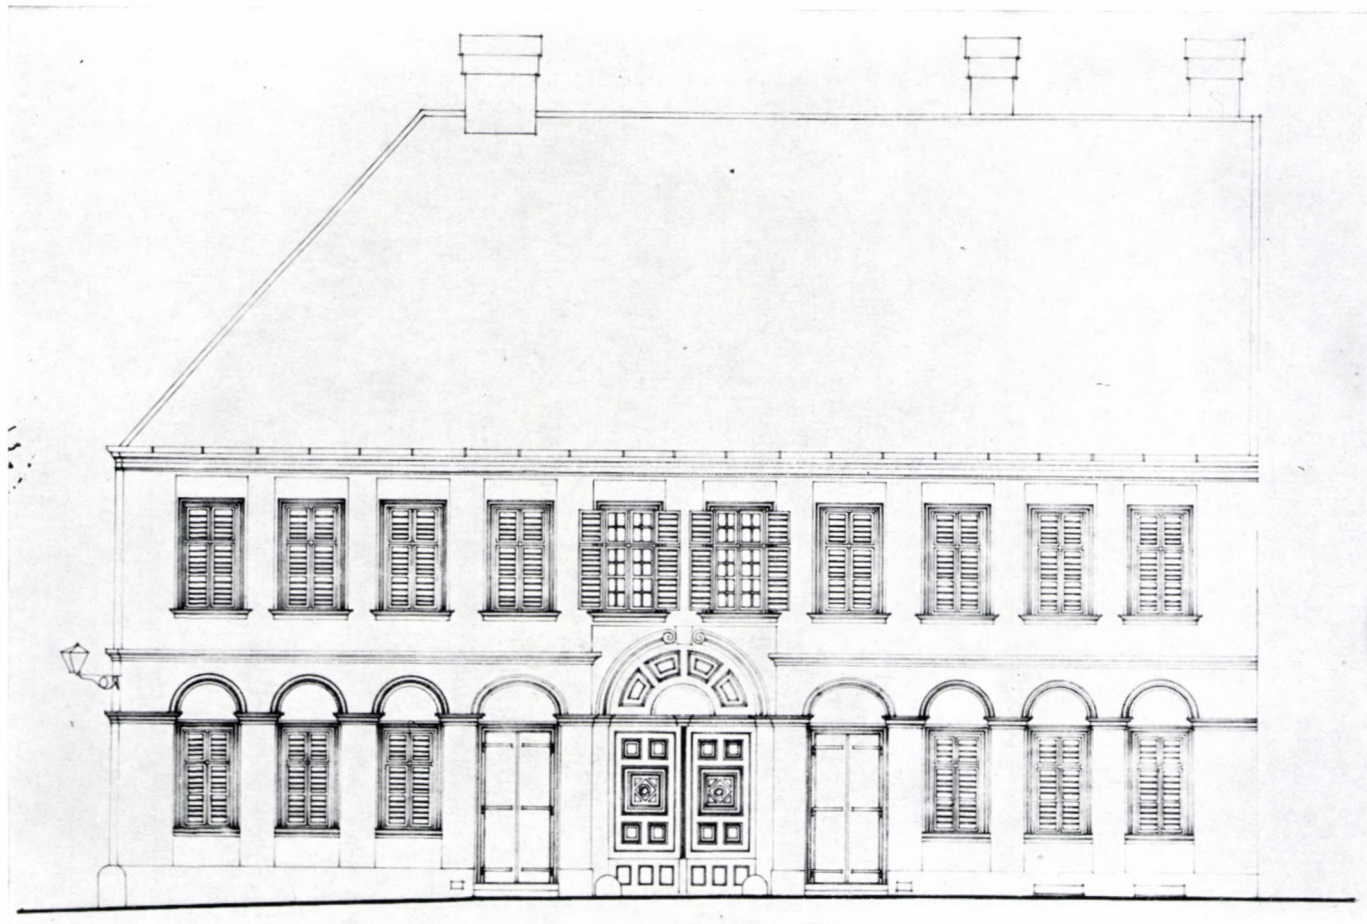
Lajos-Gasse Nr. 152 Restaurierungsplan, Fassade
